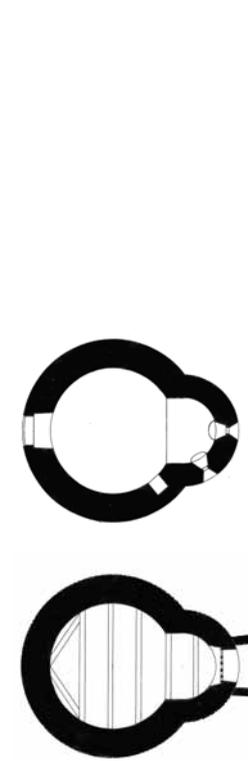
Grundrisse Rechberg, M1:200. BDA Planarchiv Wien /Wolfsgruber.
